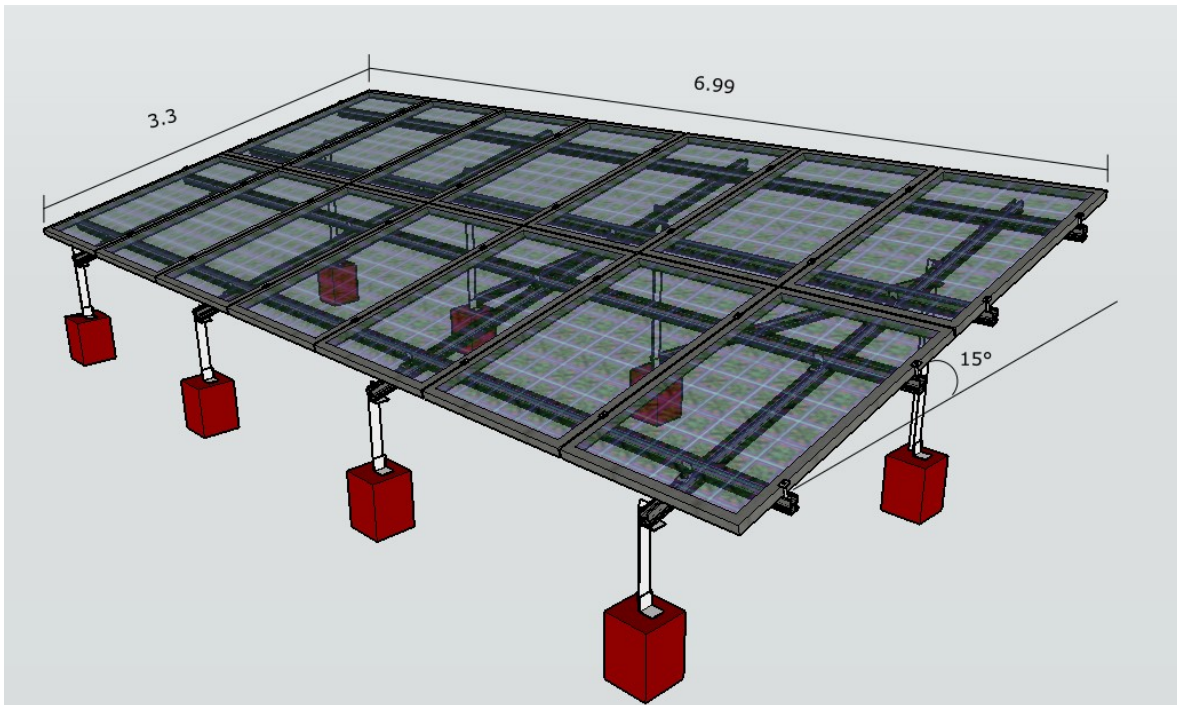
Superficie de la UBM (14MFV instalados sobre la estructura en una configuración 2 renglones por 7 columnas a la inclinación de 15°)
